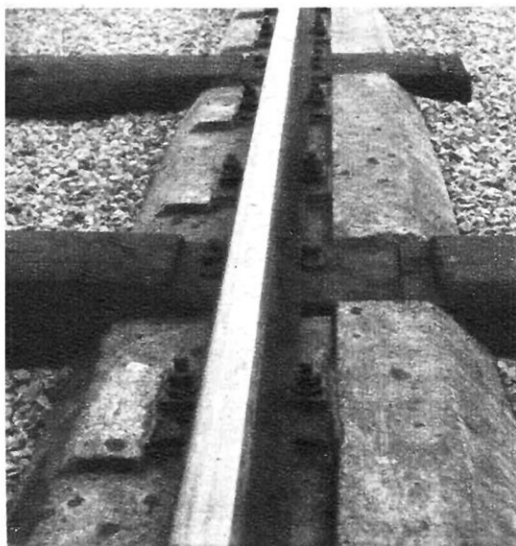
VOIE SUR LONGRINES EN BÉTON
